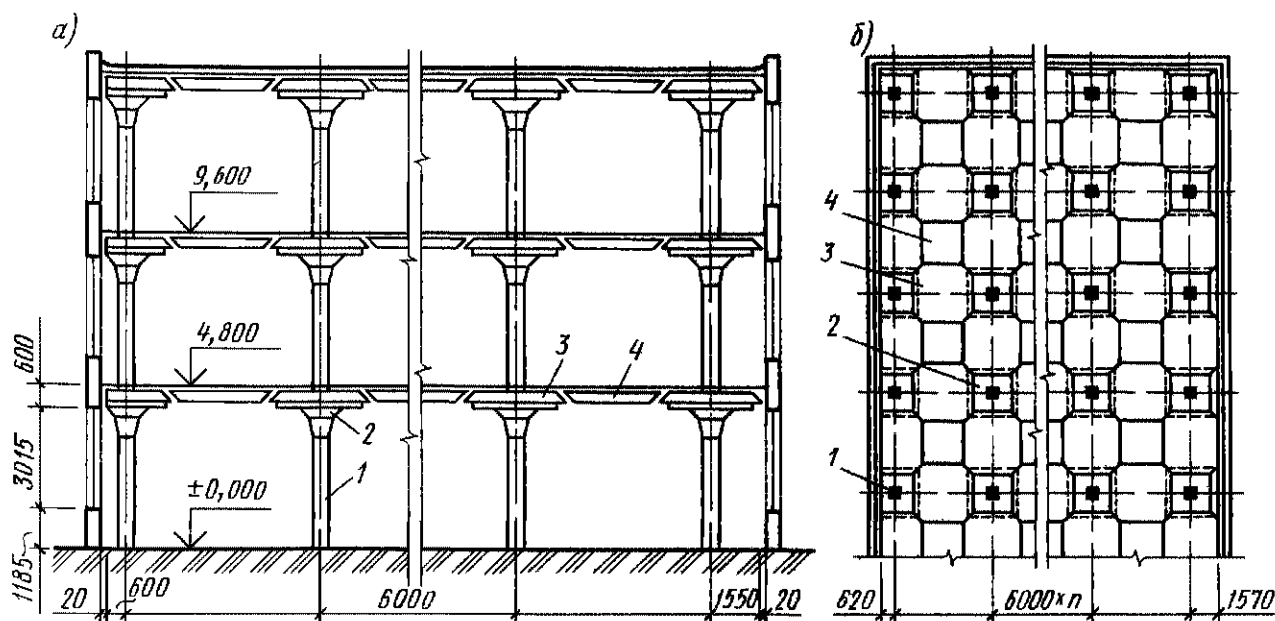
Многоэтажное сборное здание с безбалочными перекрытиями
